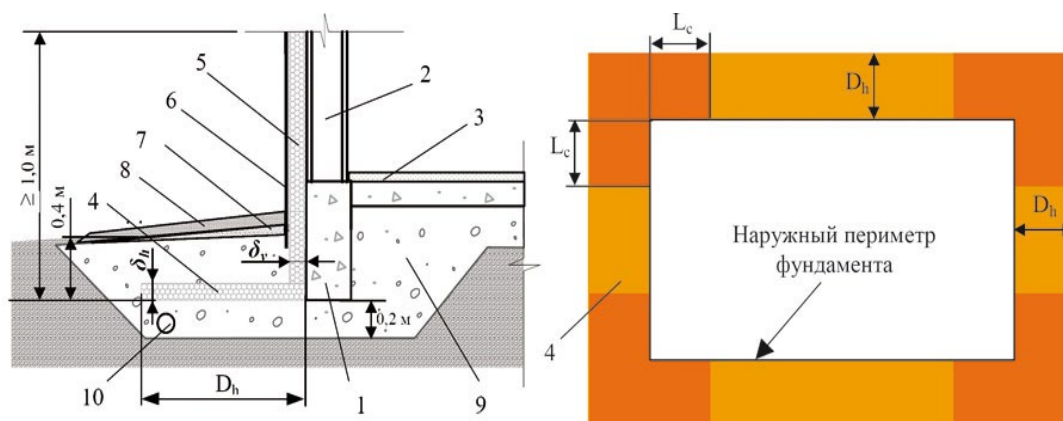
Схема теплоизоляции фундамента здания без теплоизоляции пола
